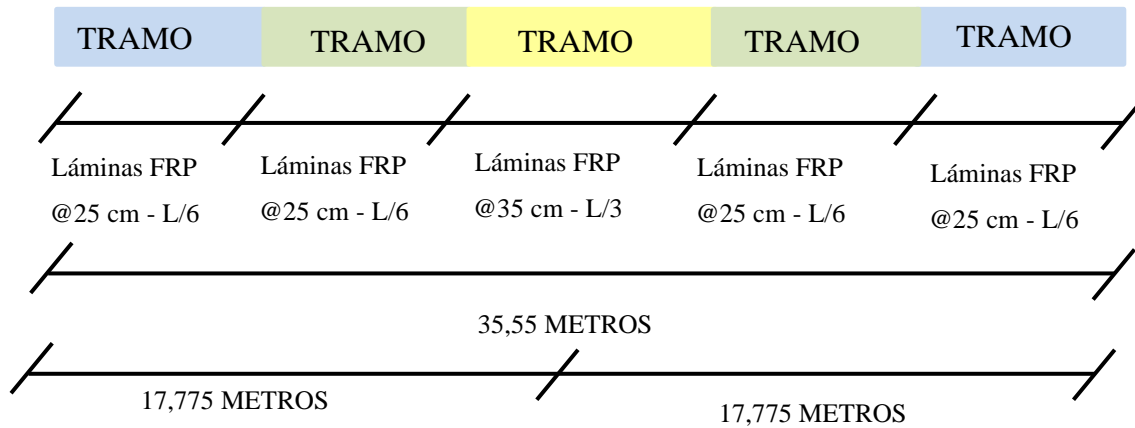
Esquema reforzamiento viga a cortante para la viga Tipo 1 (L=35.55m) (elaboración propia).
